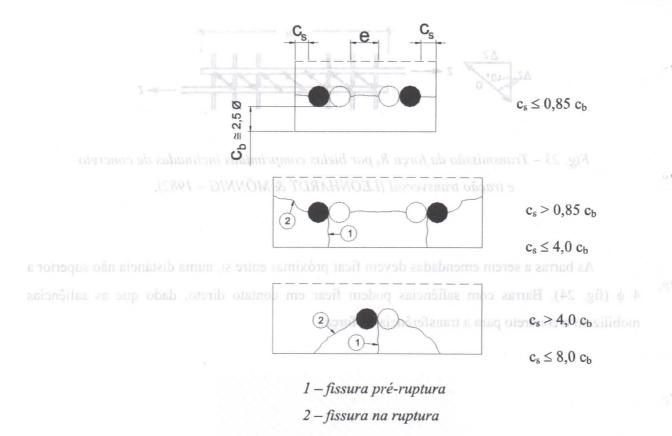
Padrão de fissuração em função da espessura do cobrimento.
